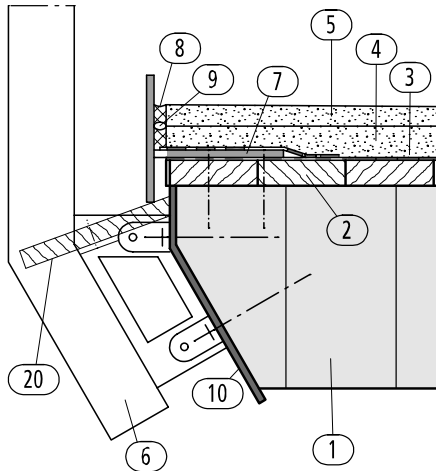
Anschluss Stahlgeländer an abgeschrägte blockverleimte Brücke, Seitenschutz mit schräger Bohle, Geh- und Radwegbrücke
